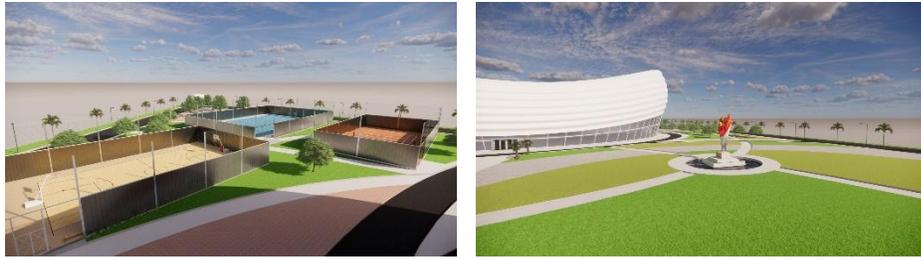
Site Plan Gelanggang Olahraga Tipe A
